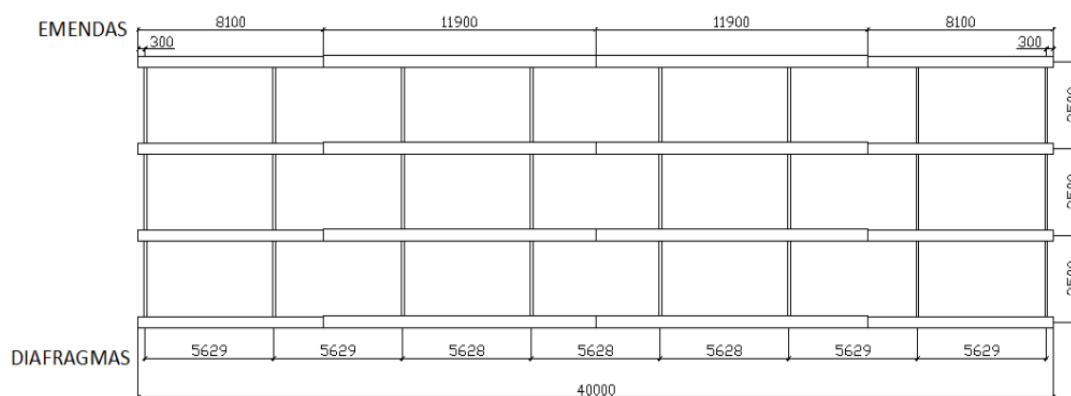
Vista em planta do modelo da ponte ortogonal em vigas mistas (adaptado de BELLEI e PINHO, 2007). Dimensões em mm.
